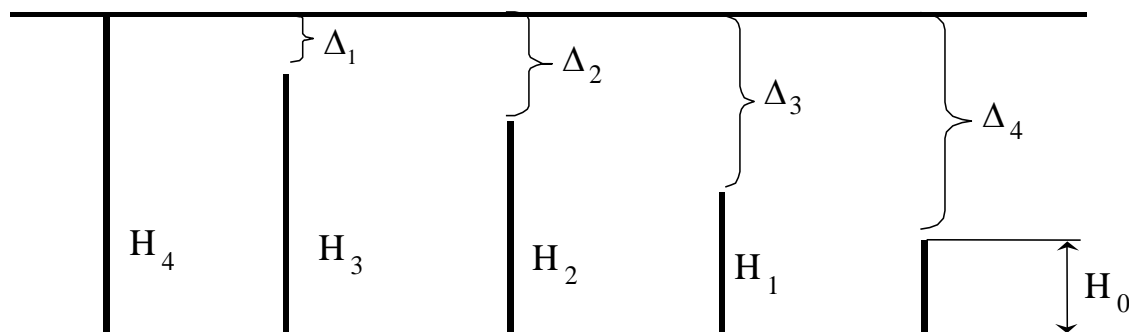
Схема розрахунку стійок для кріплення трубопроводу
